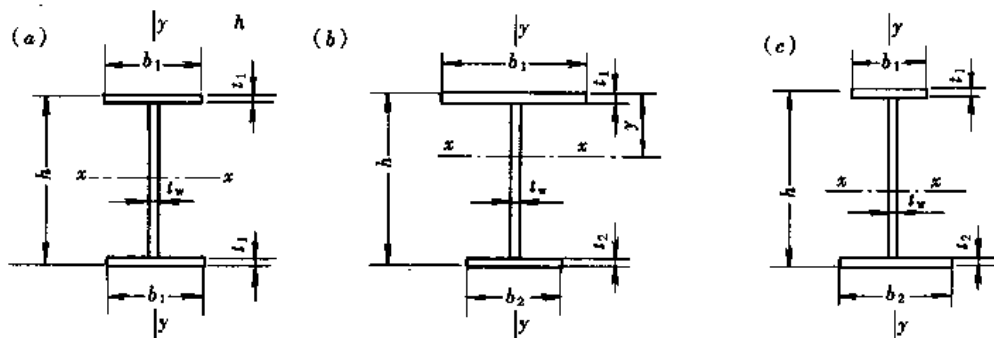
焊接工字形 (含轧制 H 型钢) 截面
